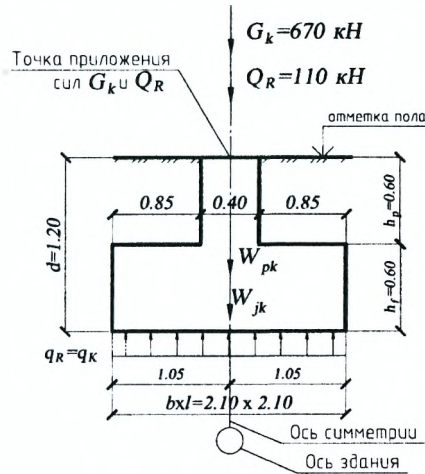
Расчётная схема фундамента к примеру (размеры в метрах)
